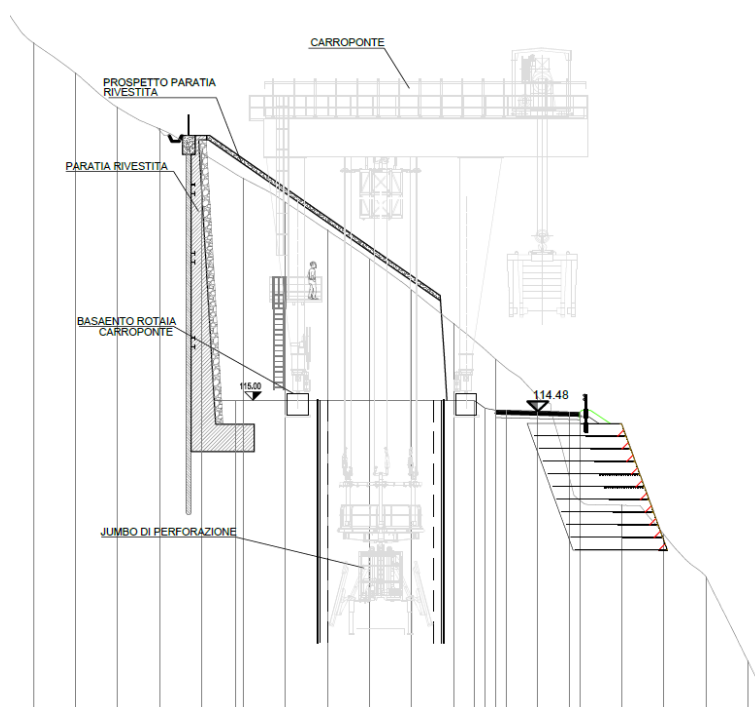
Cantiere pozzo: fase 2 – sezione in corrispondenza del pozzo e del carro ponte
